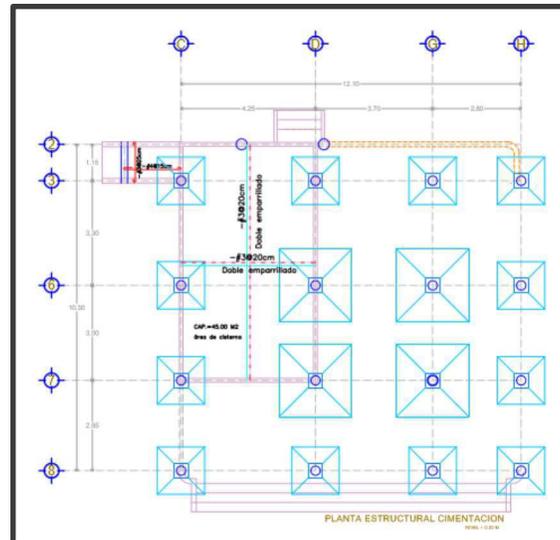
Distribución estructural de las zapatas conforme a su función de carga
